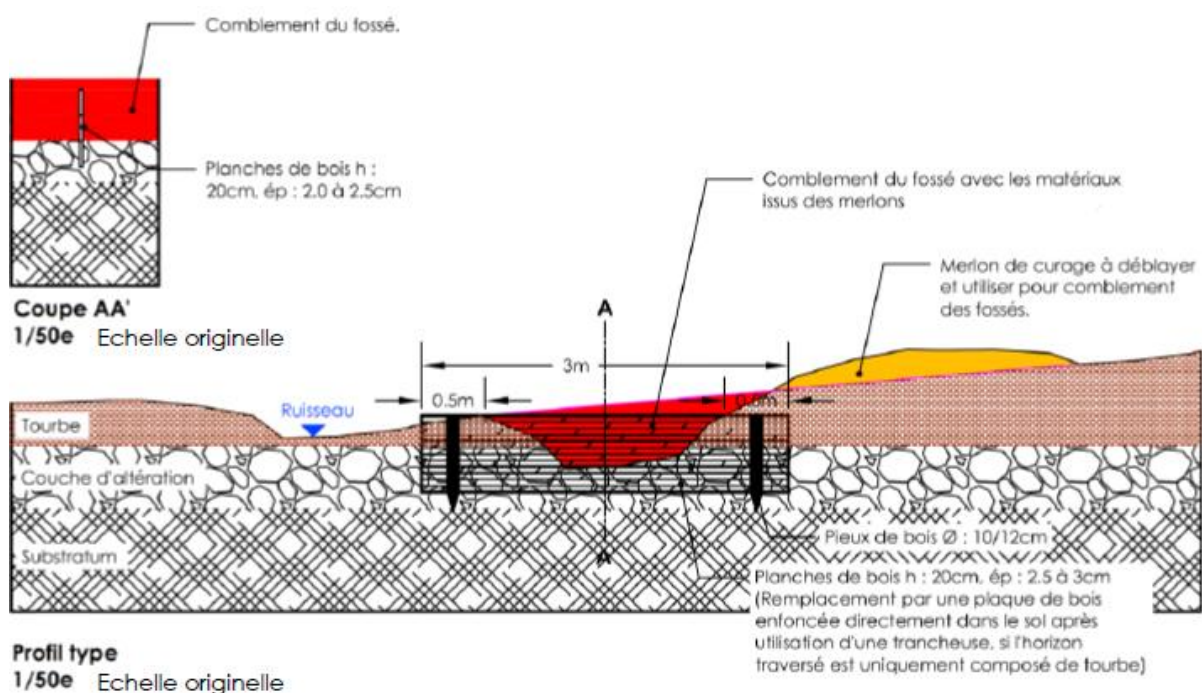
Coupe type d'un ouvrage de type barrage-bois (source : Biotec)
